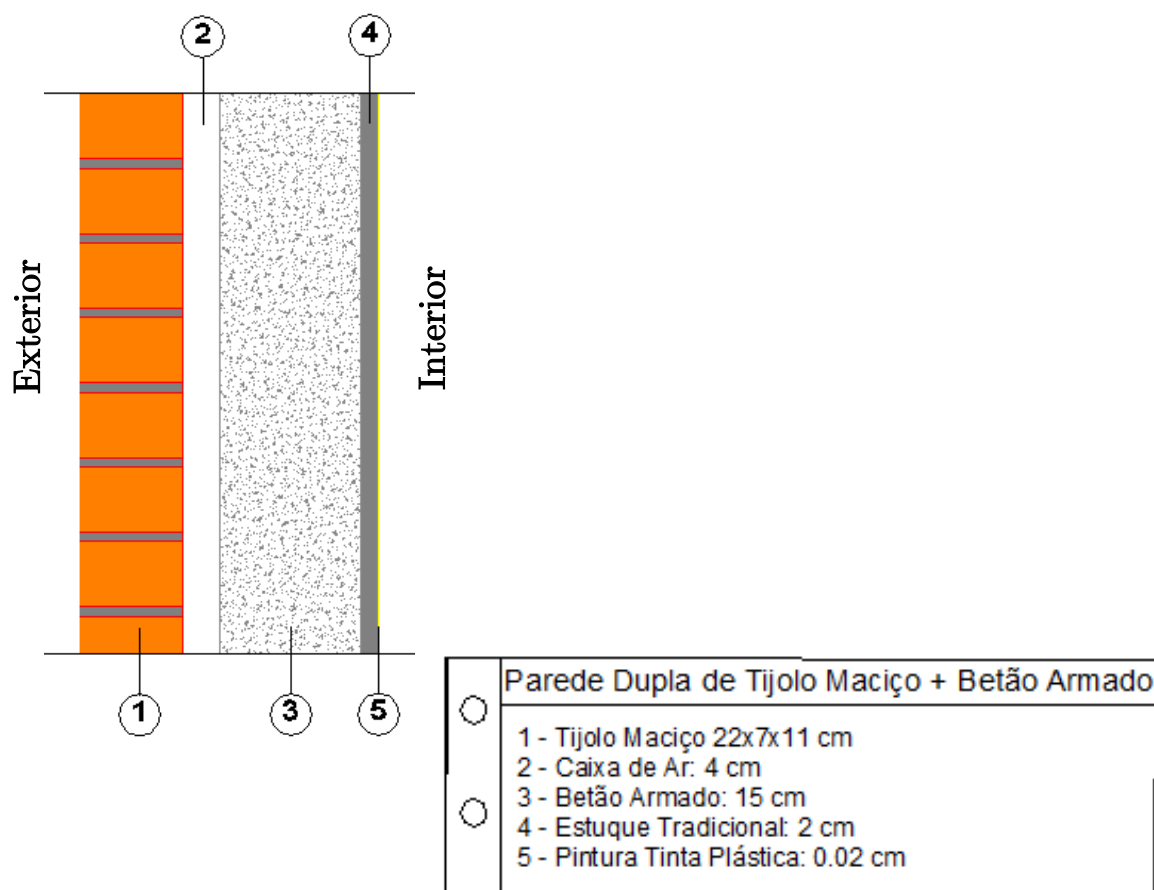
Parede dupla de tijolo maciço pelo exterior e betão armado pelo interior
